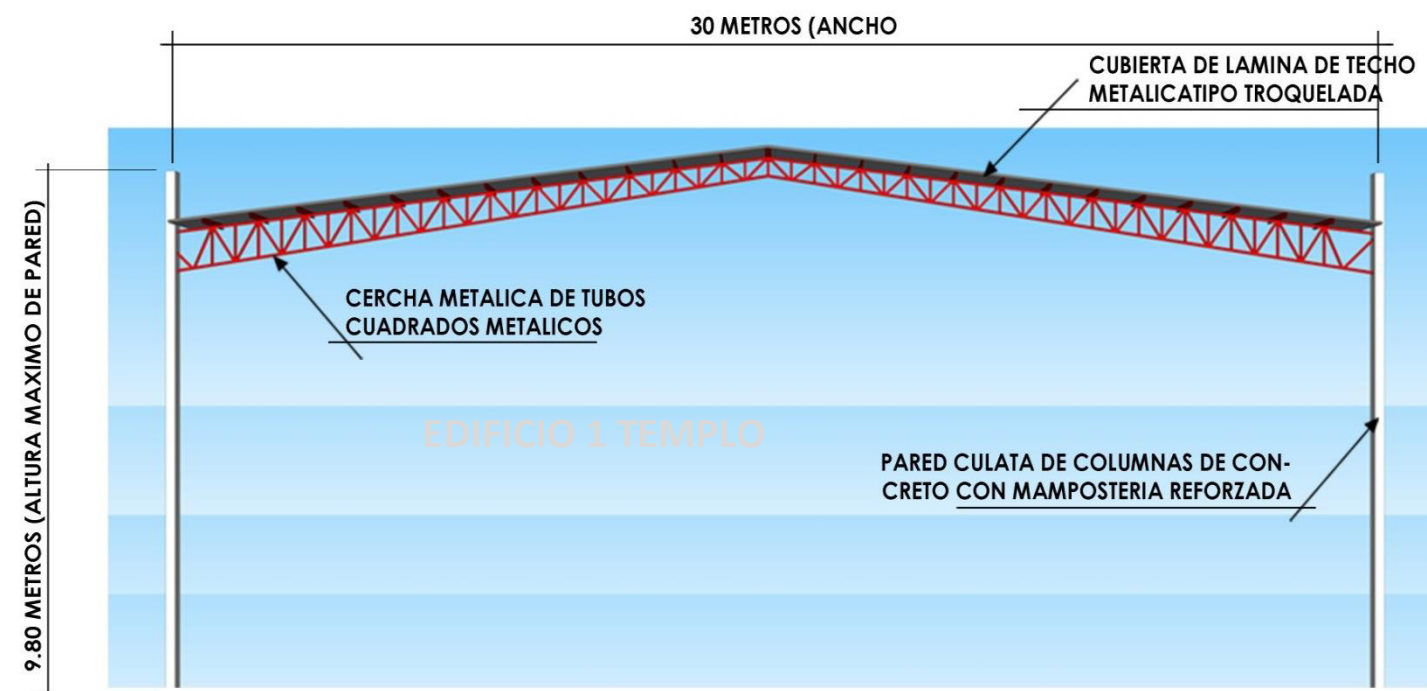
Propuesta estructural sistema de cerchas y concreto reforzado. Fuente propia
